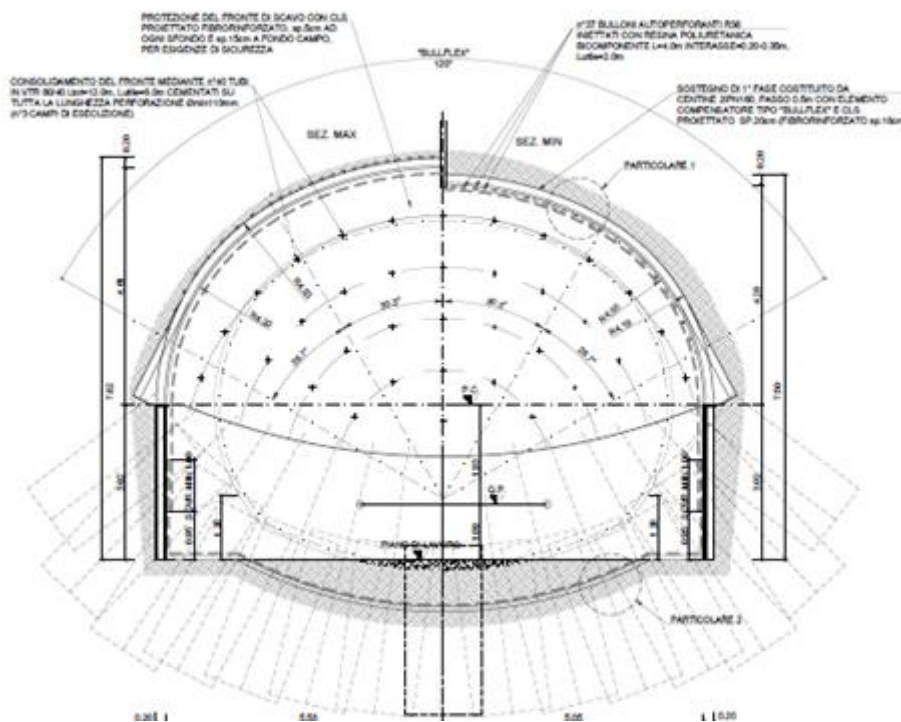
Tipologico sezione tipo 2 di scavo con consolidamenti in avanzamento a geometria troncoconica
